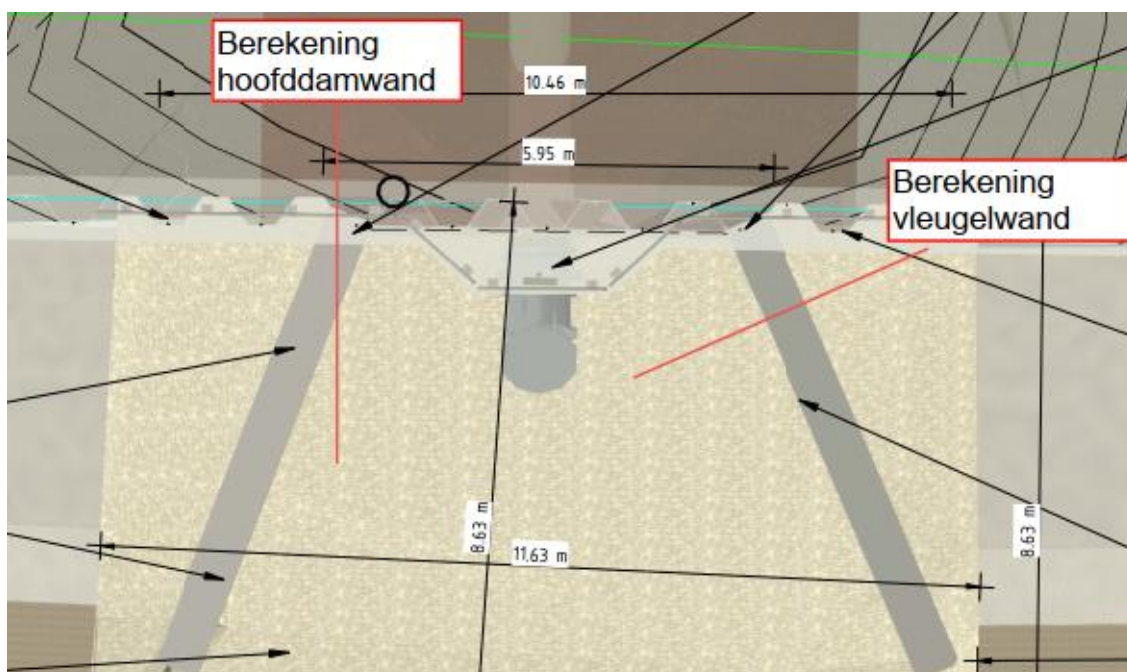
Damwandconstructie: hoofddamwand en vleugelwanden
